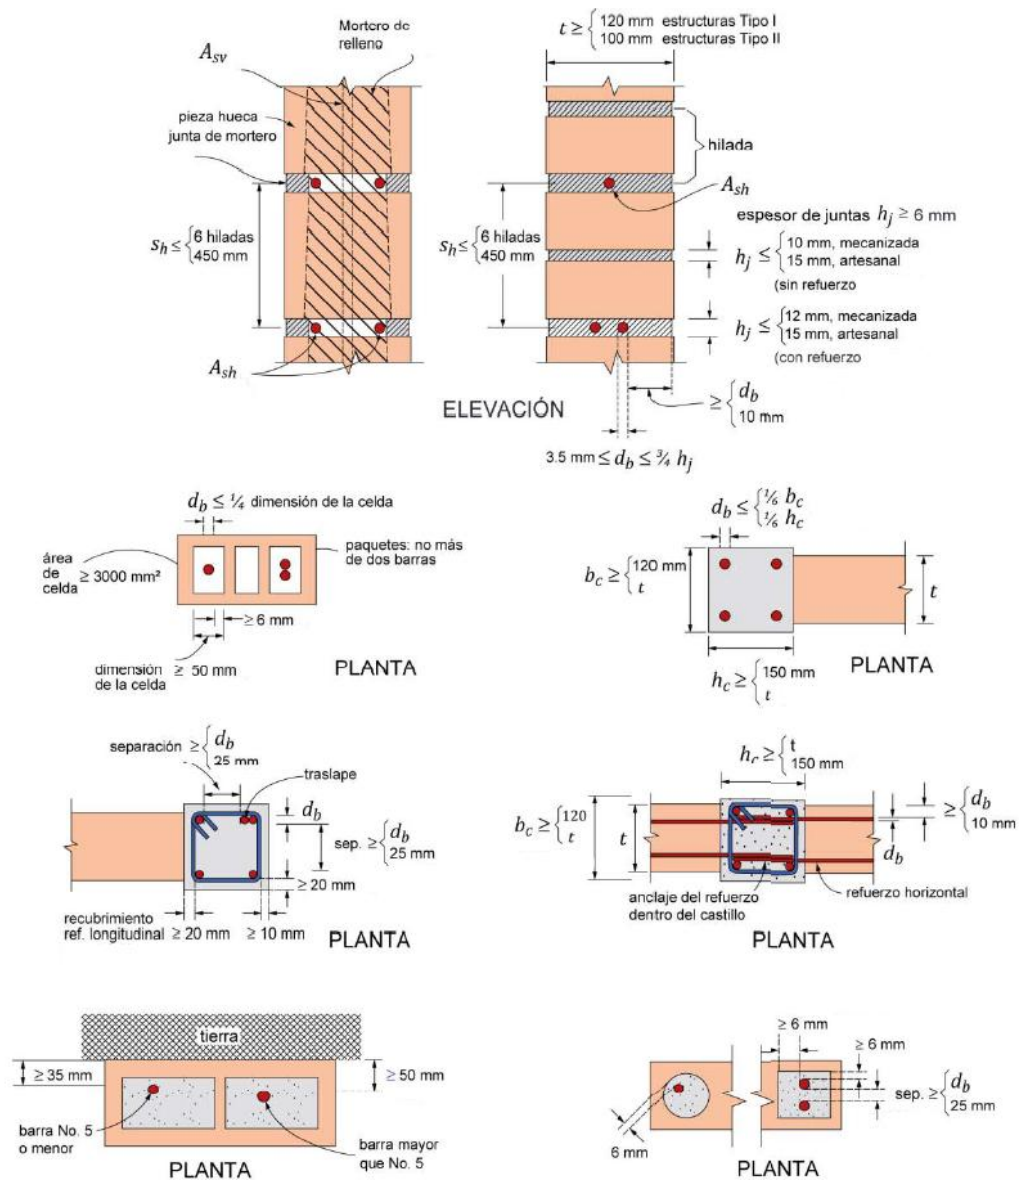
Requisitos para colocación y protección del refuerzo de la NTC-Mampostería 2023 [23].
